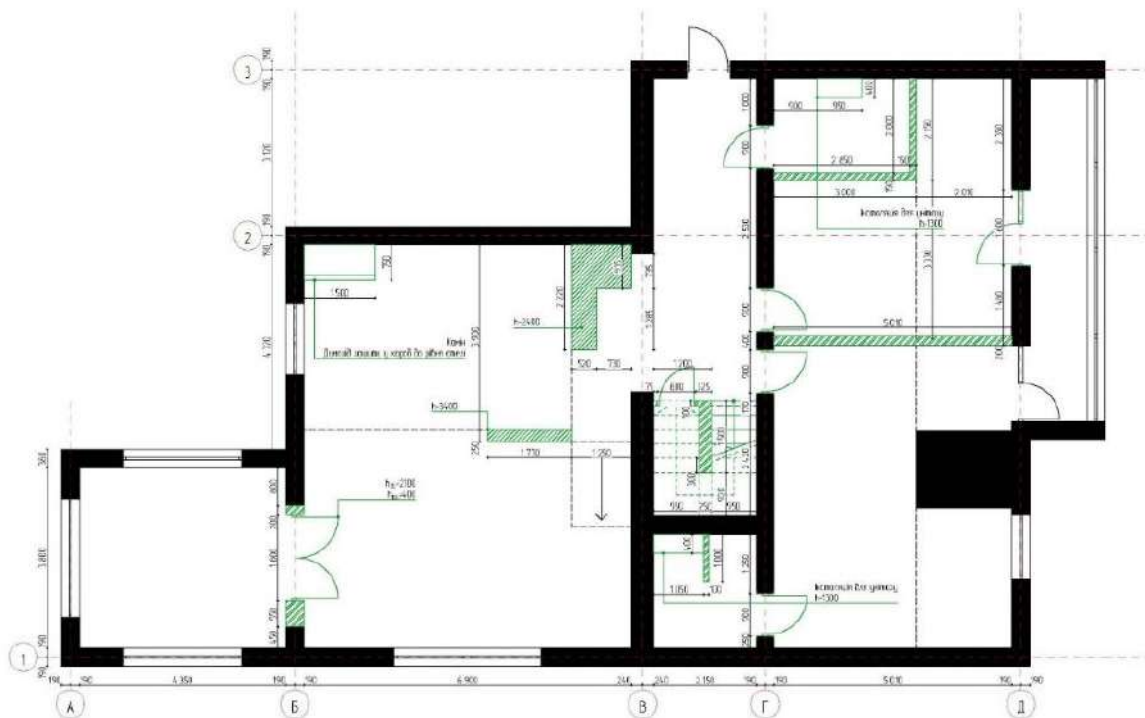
План монтажу 1-го поверху (авторське креслення).
